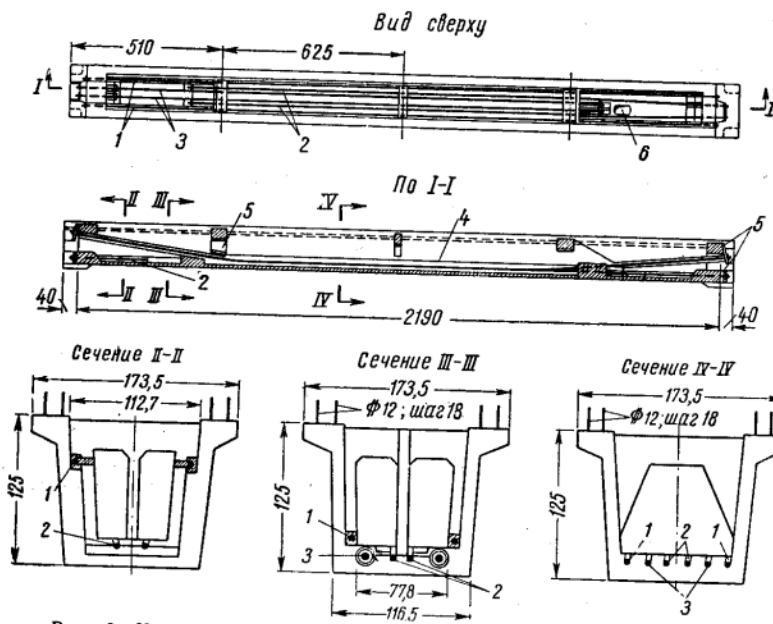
Керамзитожелезобетонная балка с предварительно напряженной арматурой
